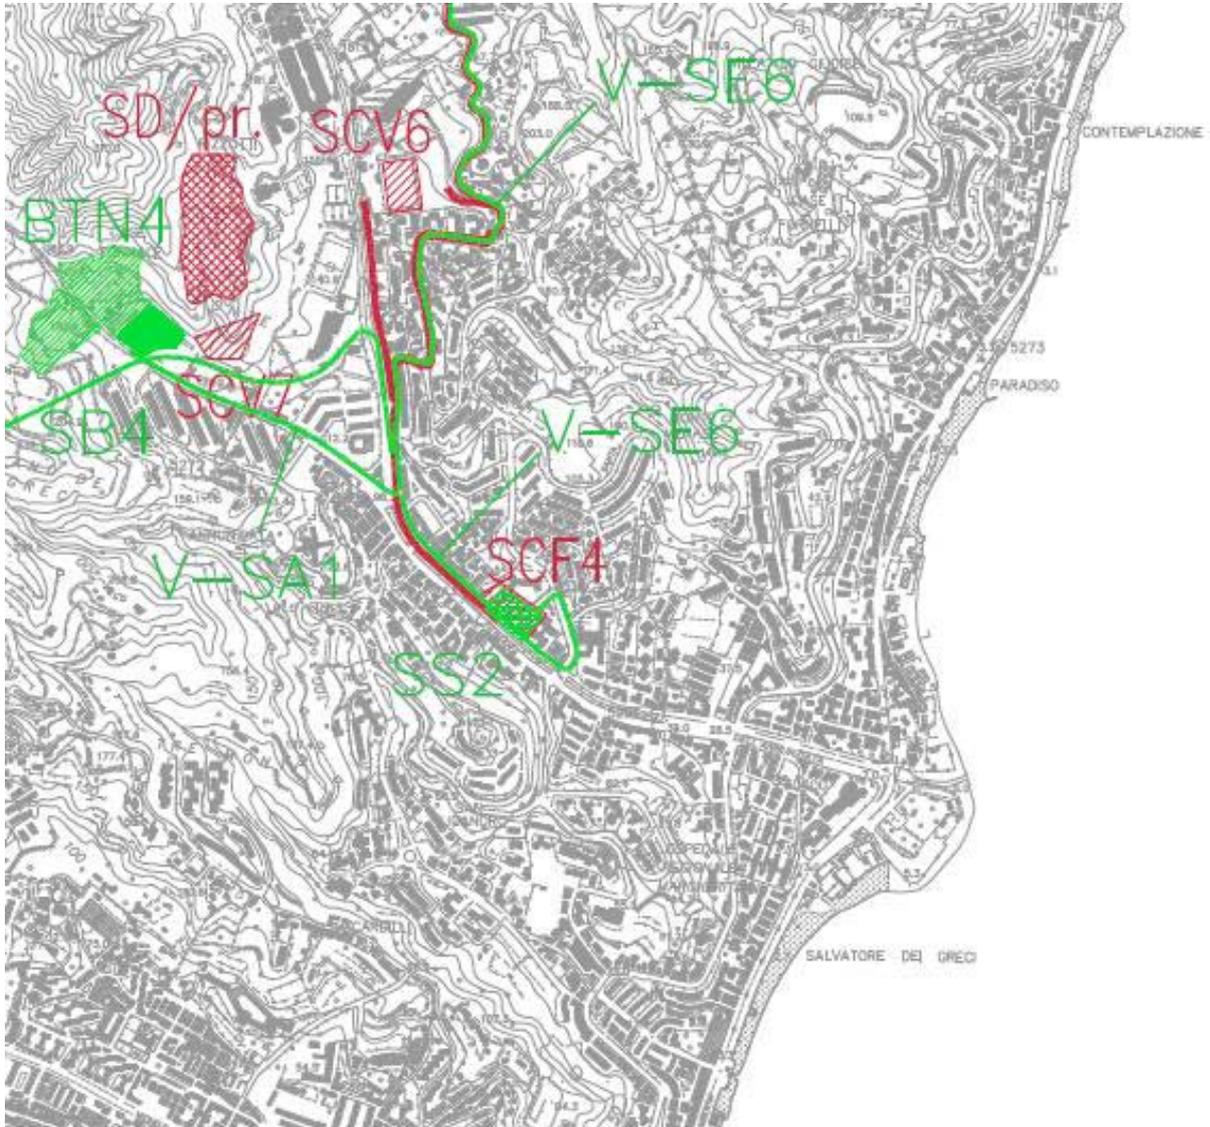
Stralcio della planimetria di confronto della cantierizzazione tra PP (aree in rosso) e PD (aree in verde) il cantiere SCF4 è destinato alla realizzazione della stazione Annunziata
